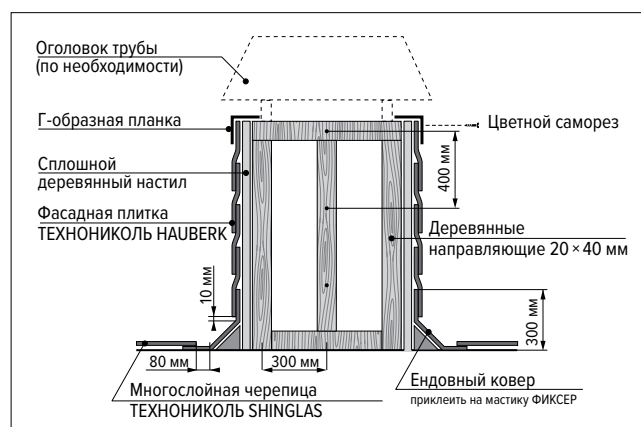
Монтаж фасадной плитки на вентиляционную трубу
